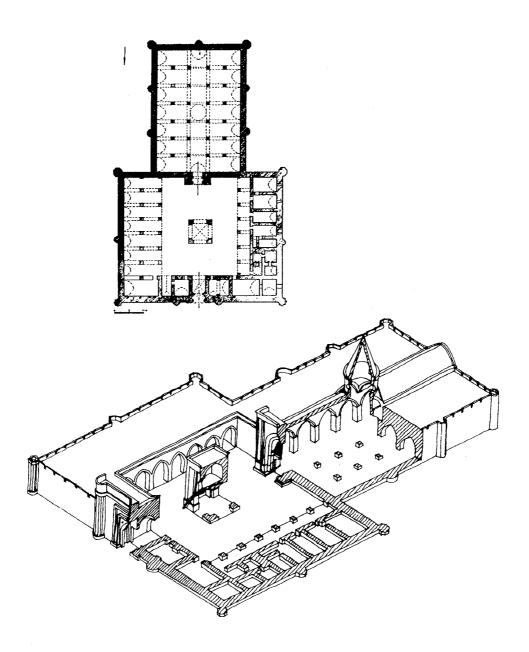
مسقط أفقى لرياط ماهي (طريق مشهد سرخس) (عن : آصلان آبا) .
